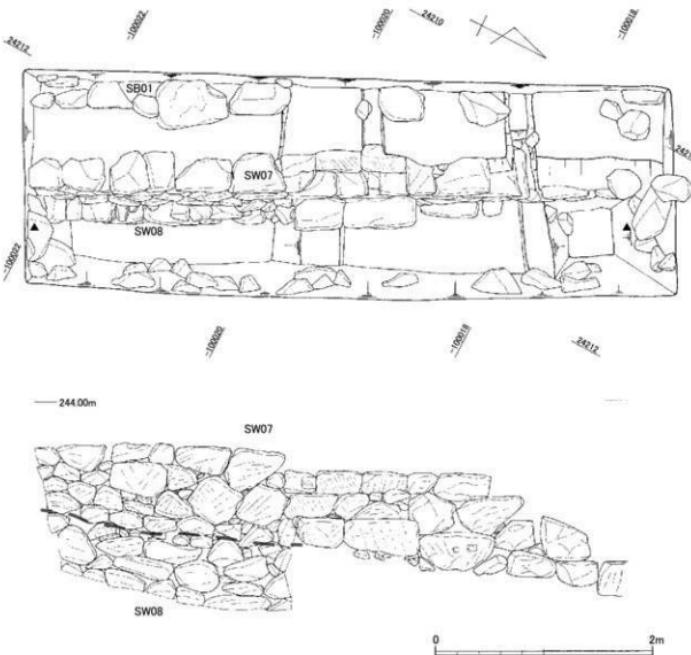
昆布山谷地区第5地点第1トレンチ平面図・立面図 (S = 1 / 40)
